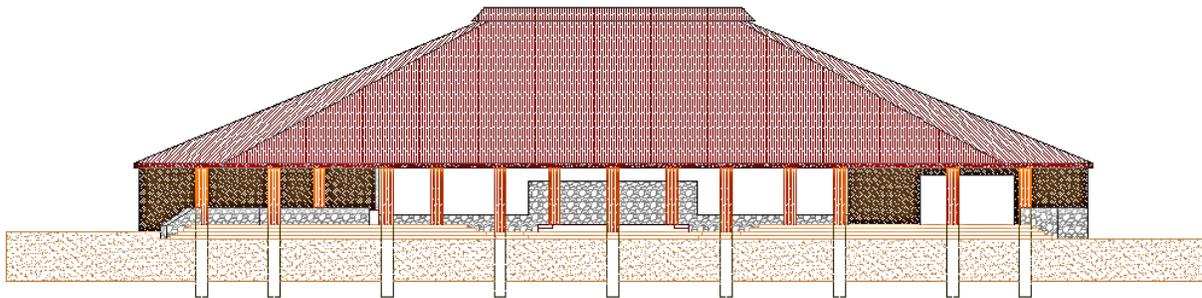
Corte estructural donde se observa el hincado de pilotes que dará soporte a la palapa. Fuente promovente.
